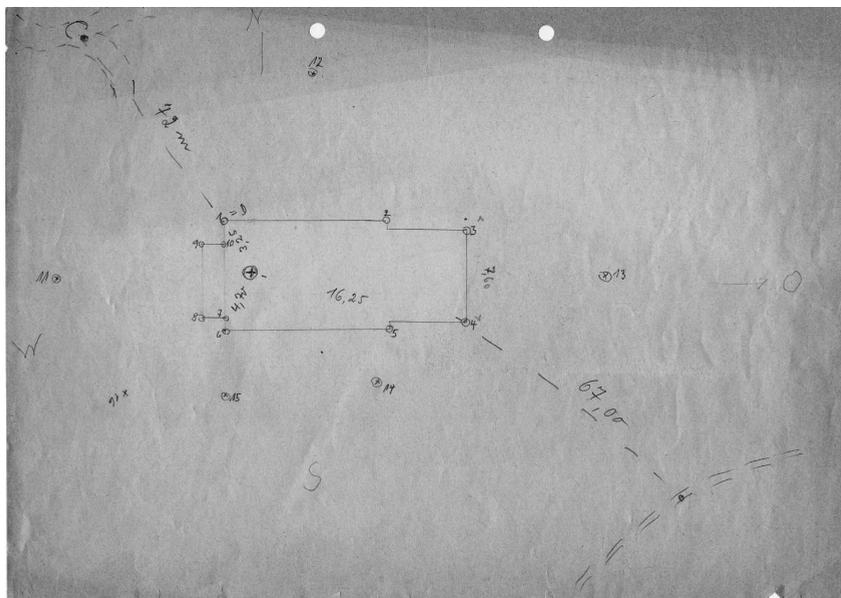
W. Küther, Blatt 1, Grundrisssskizze Kirchenruine Nieder-Albach, 1970
